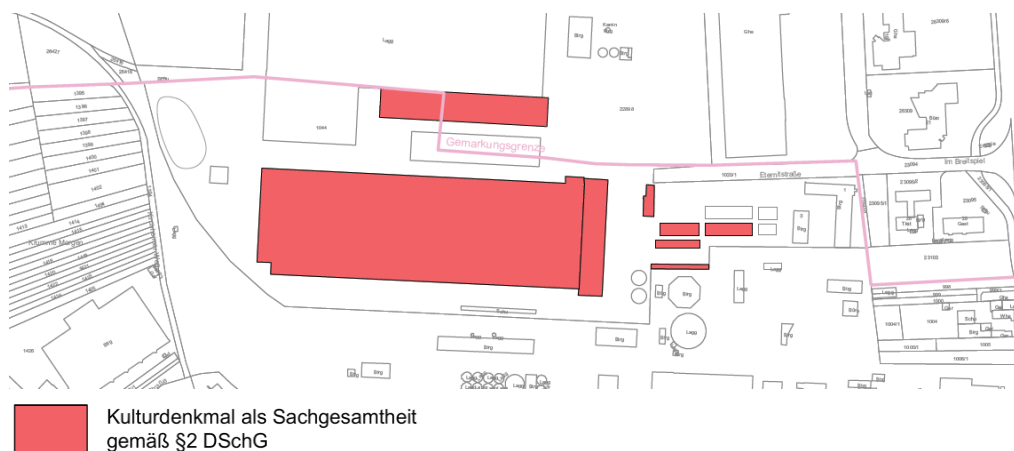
Lageplan Denkmalschutz „Eternit“
